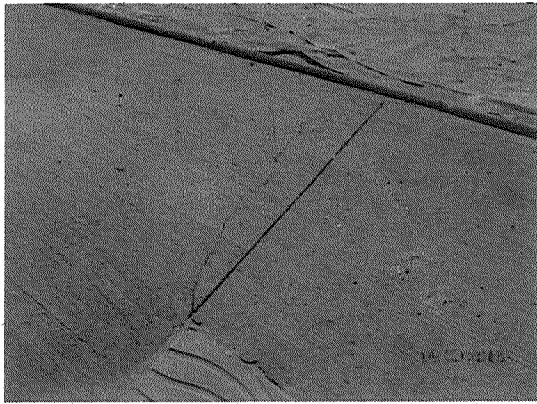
Pavimento de hormigón a la vista agrietado.
